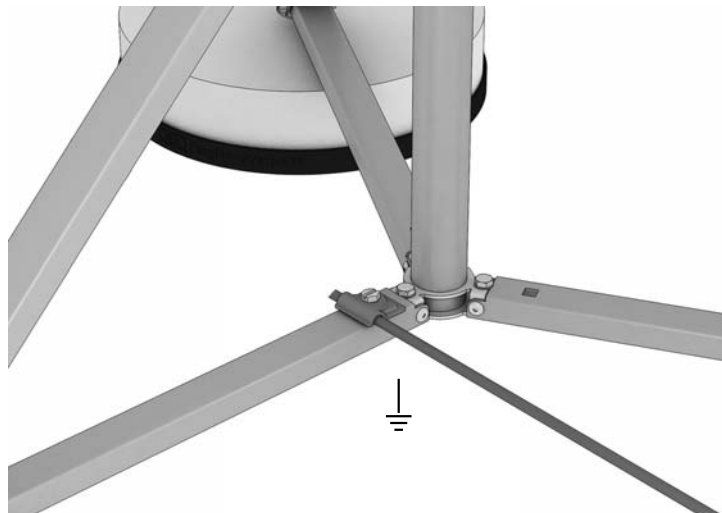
Potentialausgleich an isolierten Fangmastständer anschließen
